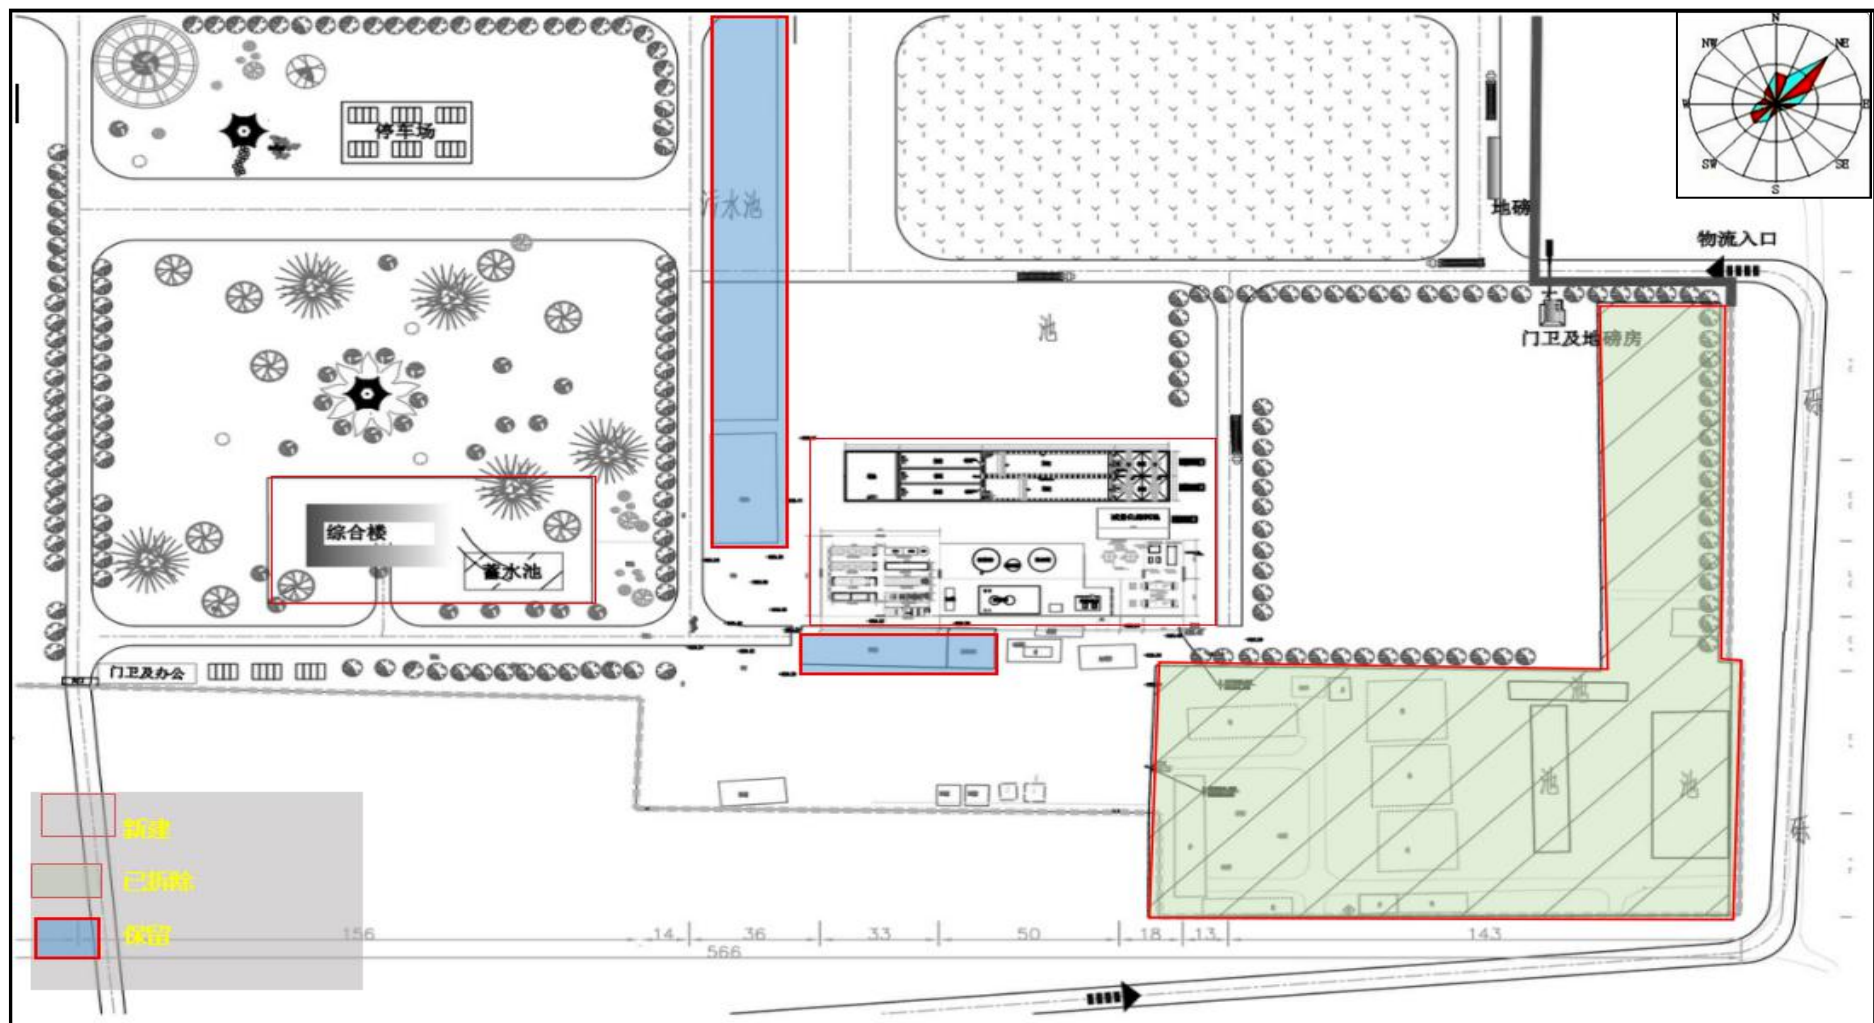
废液处理及减量化系统改造工程平面布置示意图
